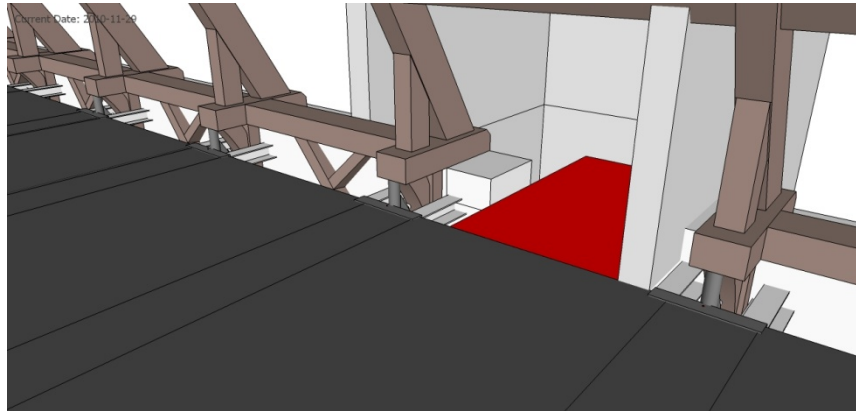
Coulage de la dalle de l'escalier et raccord avec la dalle de la galerie.
